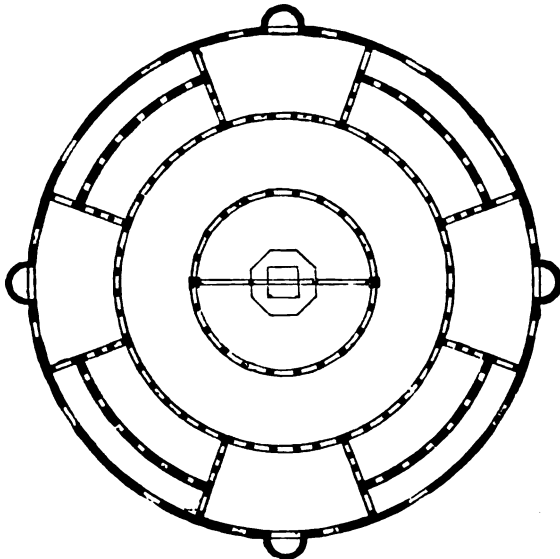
Grundriss von S. Stefano Rotondo in Rom.
